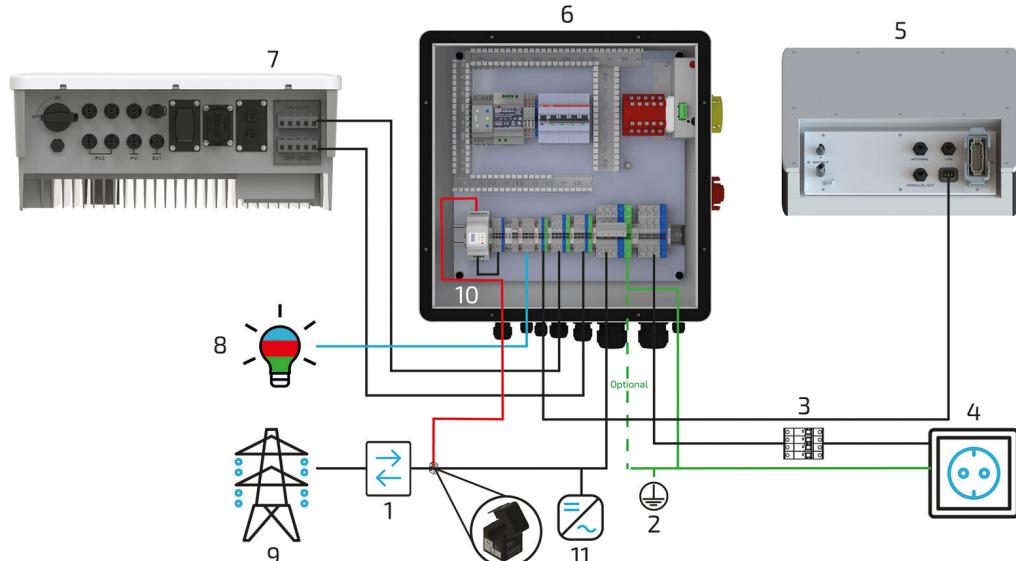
Installationsübersicht mit externem AC-Erzeuger
